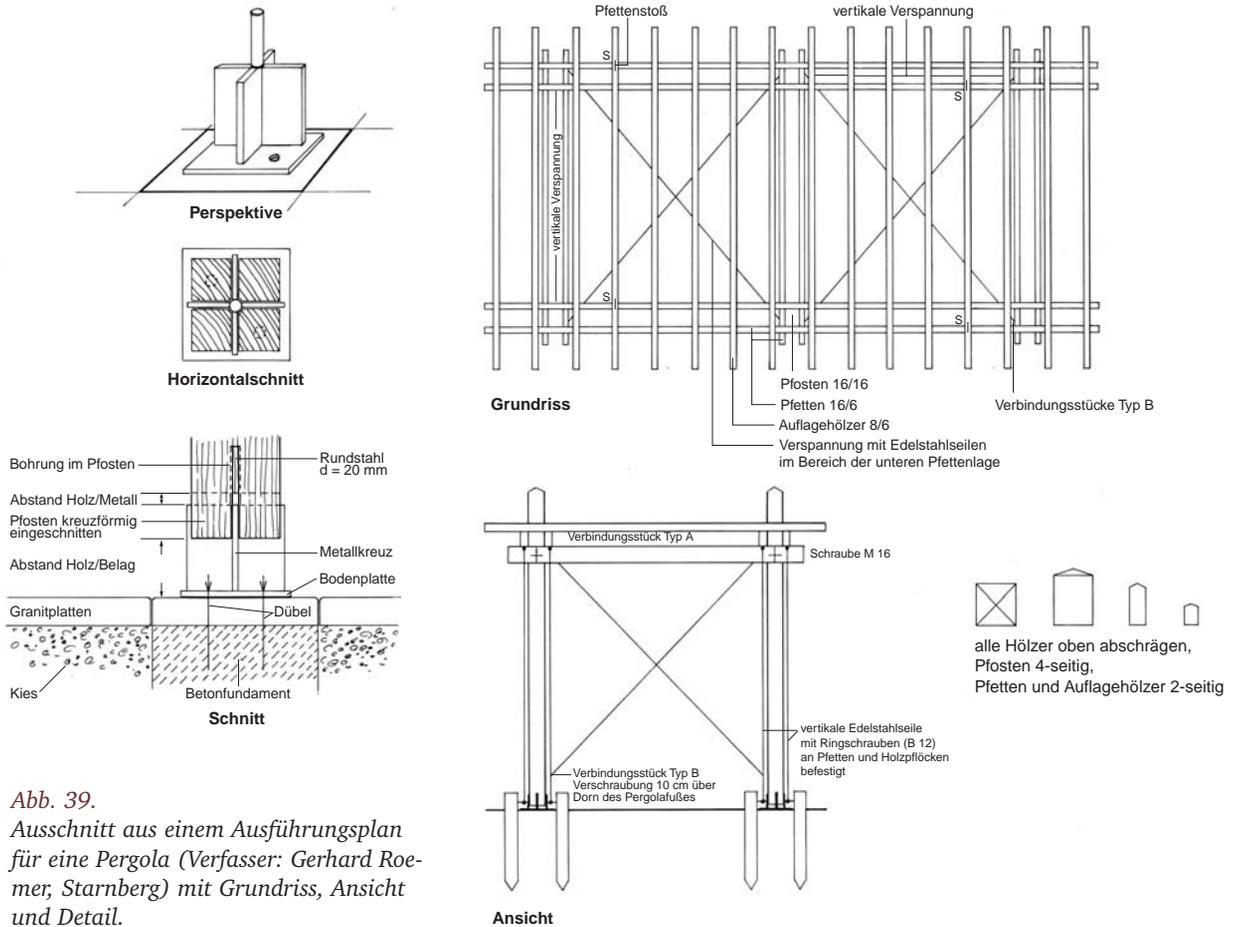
Ausschnitt aus einem Ausführungsplan für eine Pergola (Verfasser: Gerhard Roemer, Starnberg) mit Grundriss, Ansicht und Detail.
